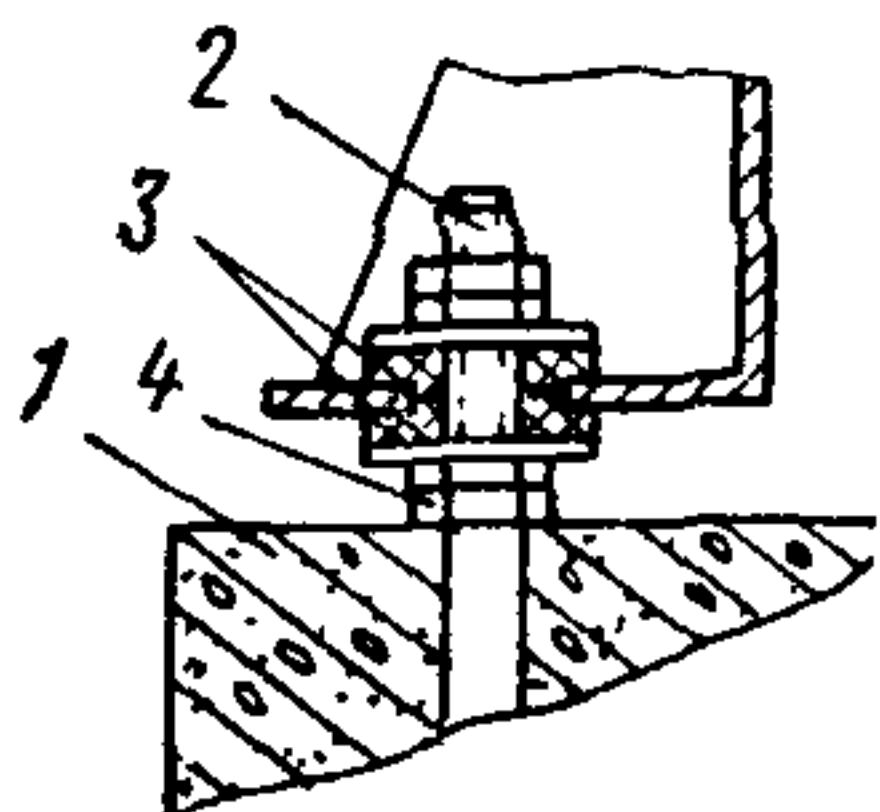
Пример изоляции металлической опоры от арматуры и бетона фундаментов
